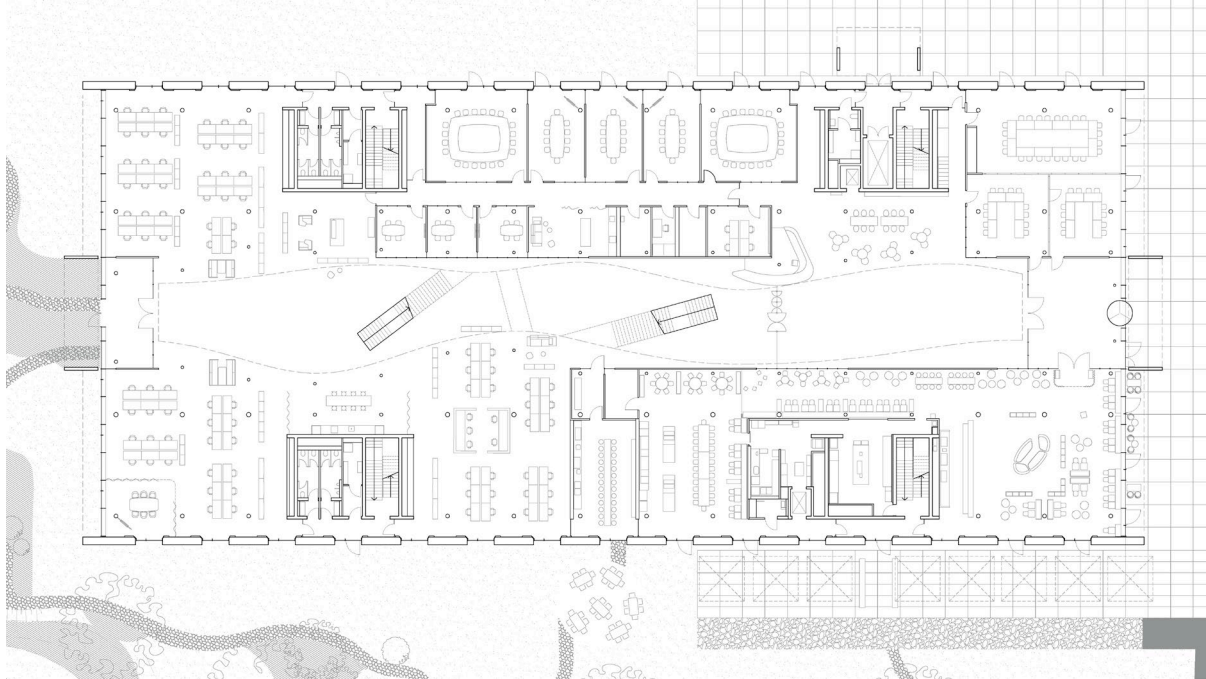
Grundriss Erdgeschoss Arbeitswelt haascookzemmrich STUDIO2050
